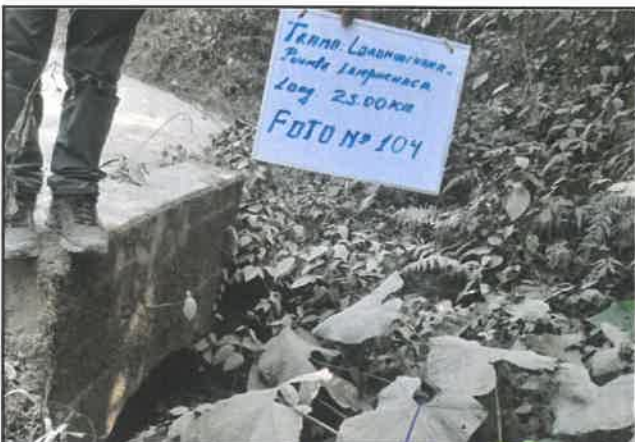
Alcantarilla de concreto armado en estado regular, progresiva 06+440.
